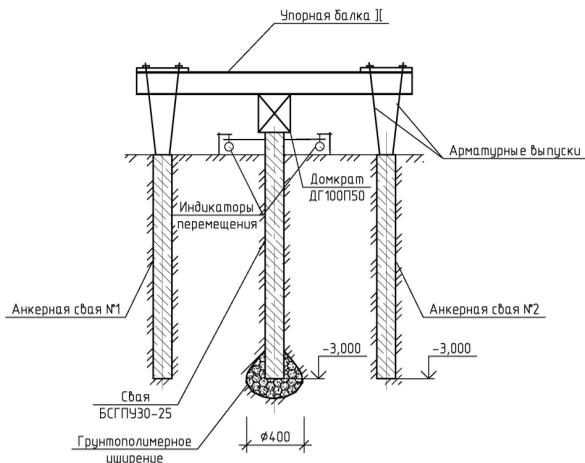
Схема испытания сваи вертикальной статической вдавливающей нагрузкой
